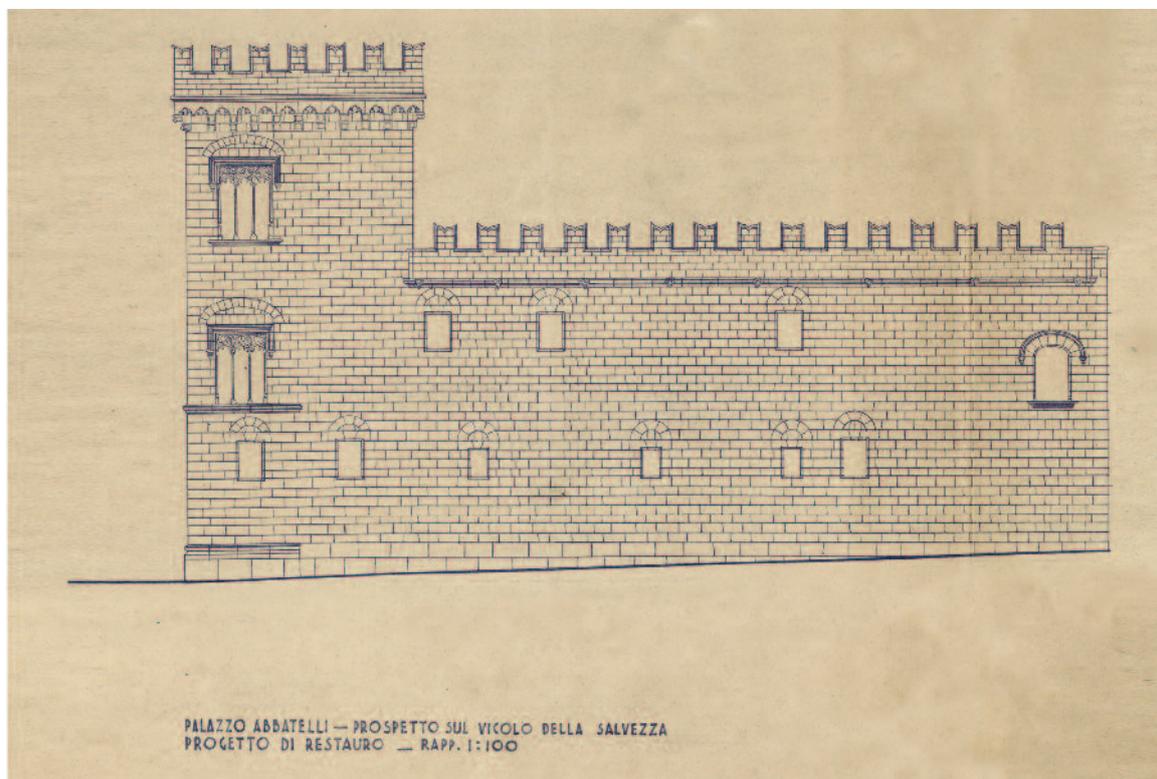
Palermo, palazzo Abatellis, vicolo della Salvezza, progetto di ricostruzione del prospetto (Archivio fotografico SBBCCAAP).
